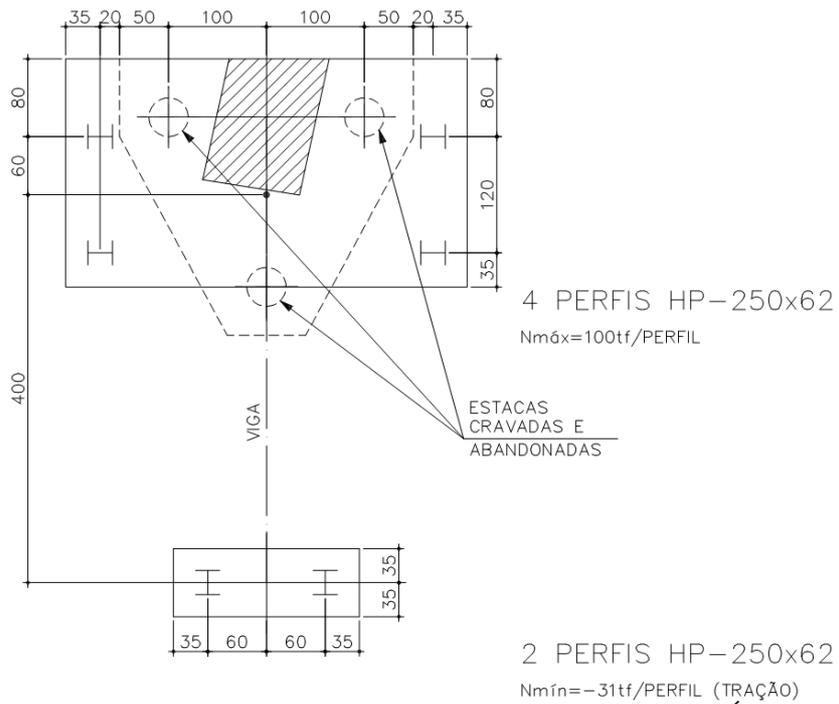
Detalhe do reforço da fundação do apoio 1. (Fonte: VITÓRIO, 2014)
